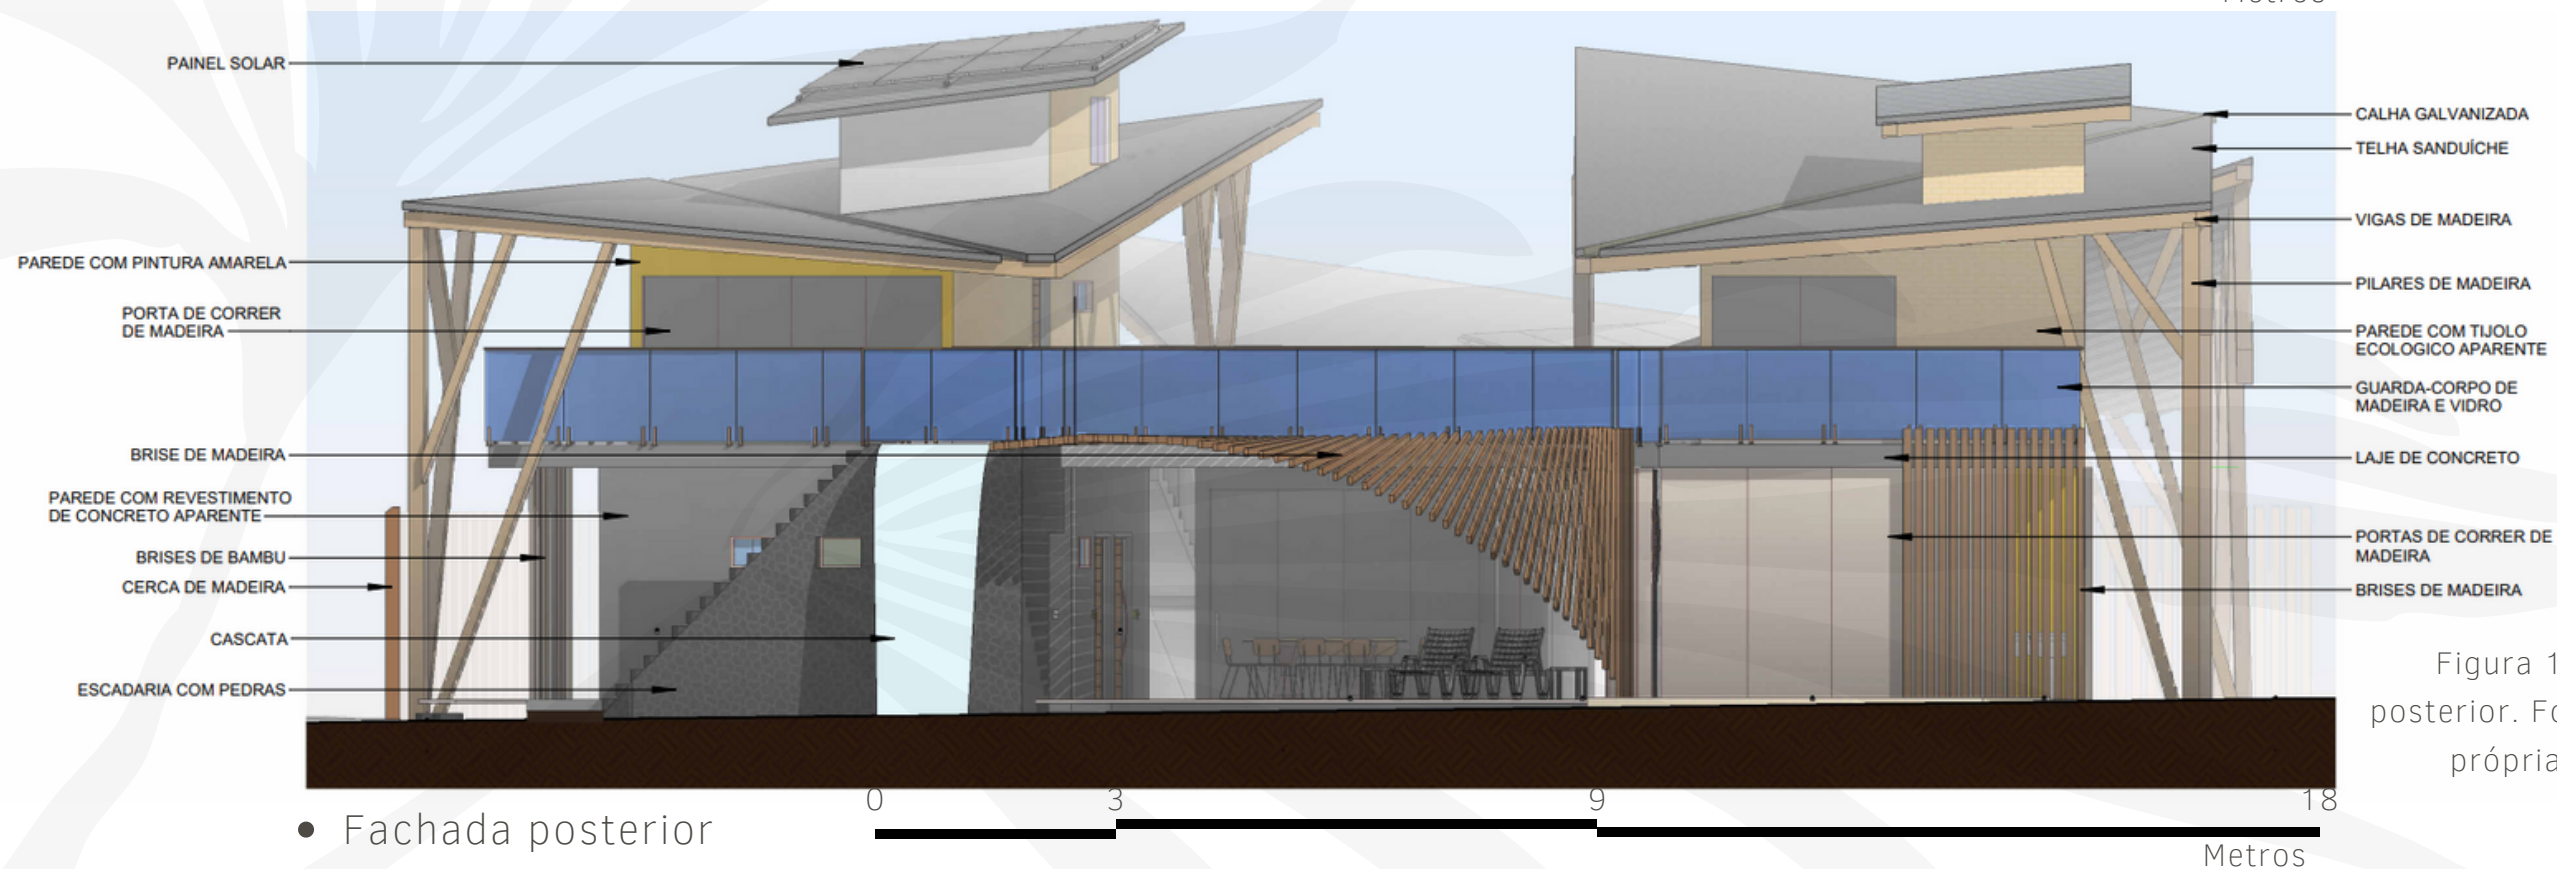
Fachada posterior. Fonte: Elaboração própria da autora.
